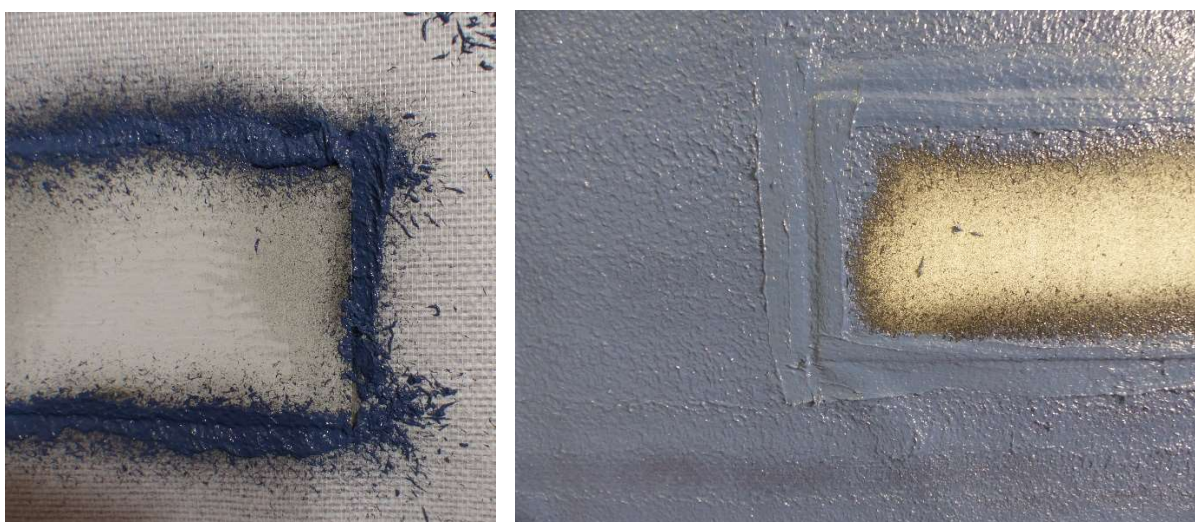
Auffüllen des Spaltes um die Betonplatte (links) und Situation nach dem Auftragen der Flächenabdichtung um die Betonfläche herum.
